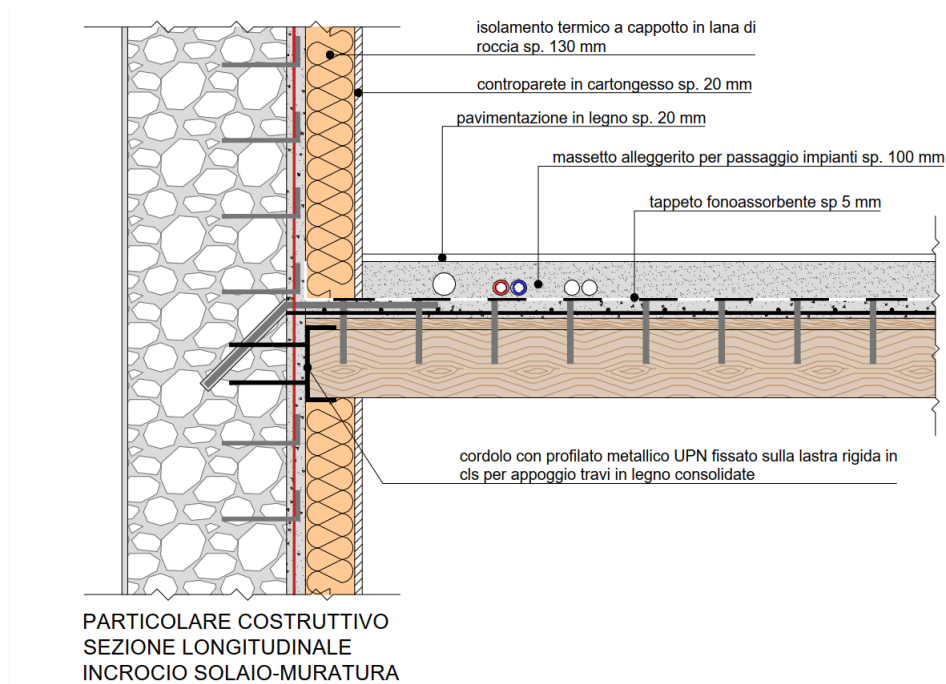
Particolare costruttivo incrocio solaio muratura – Sezione longitudinale
